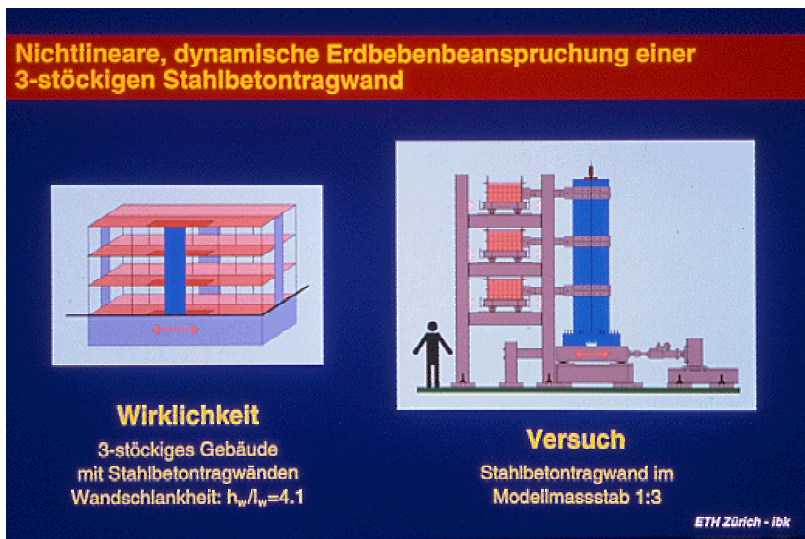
Wirklichkeit und dynamische Versuche bei einem 3-stöckigen Gebäude
